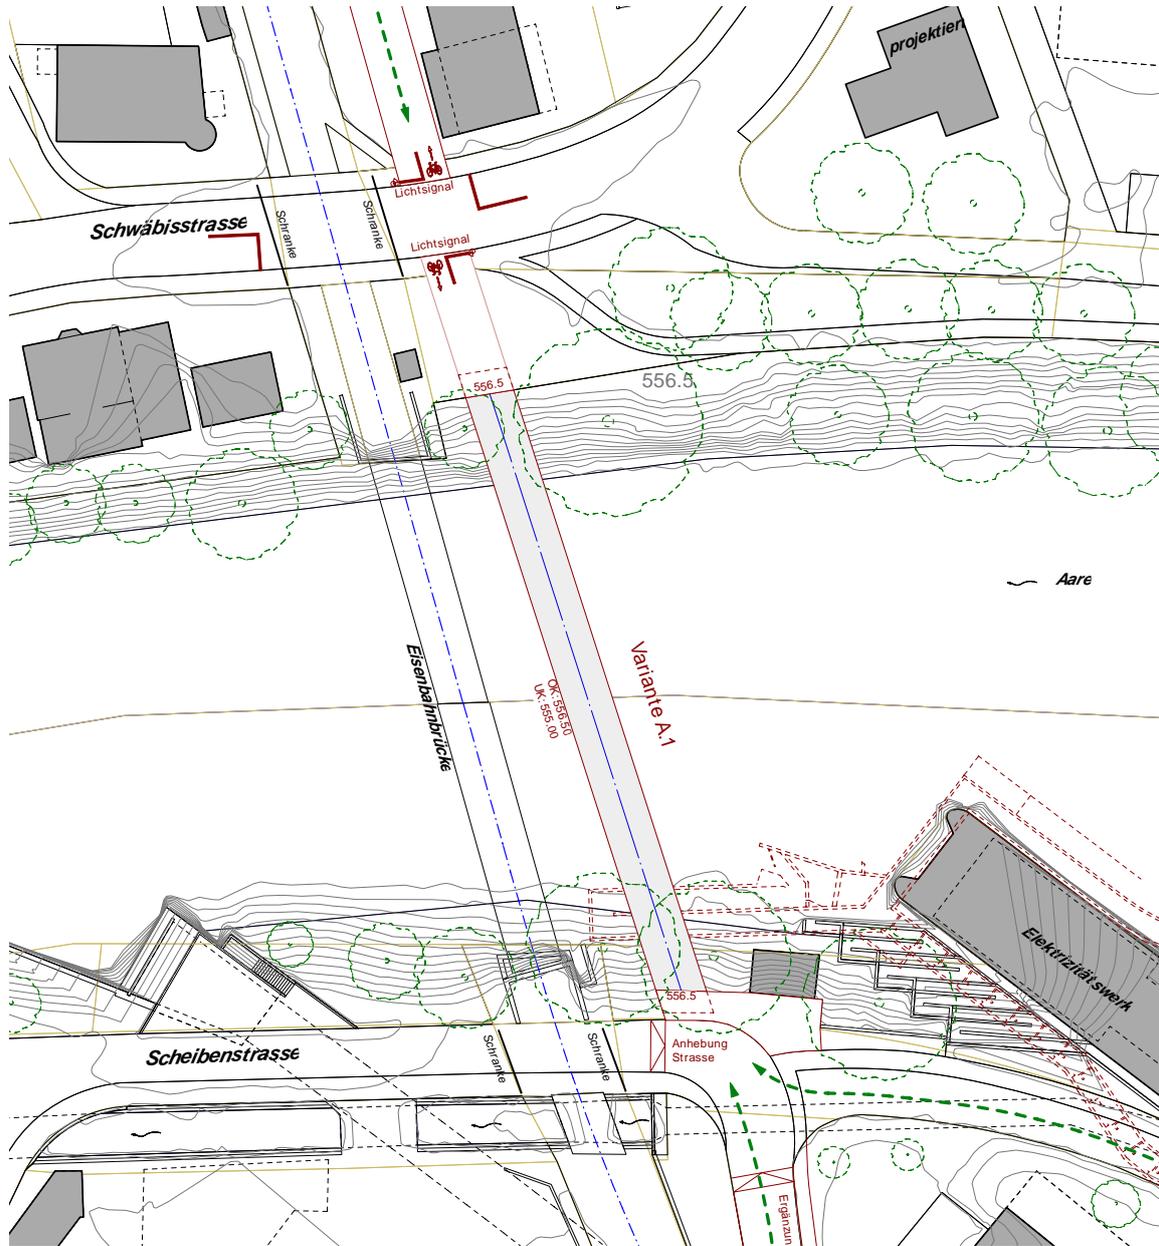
Variante A.1, Plan genordet, o. Masstab (A3-Plan im Anhang)
